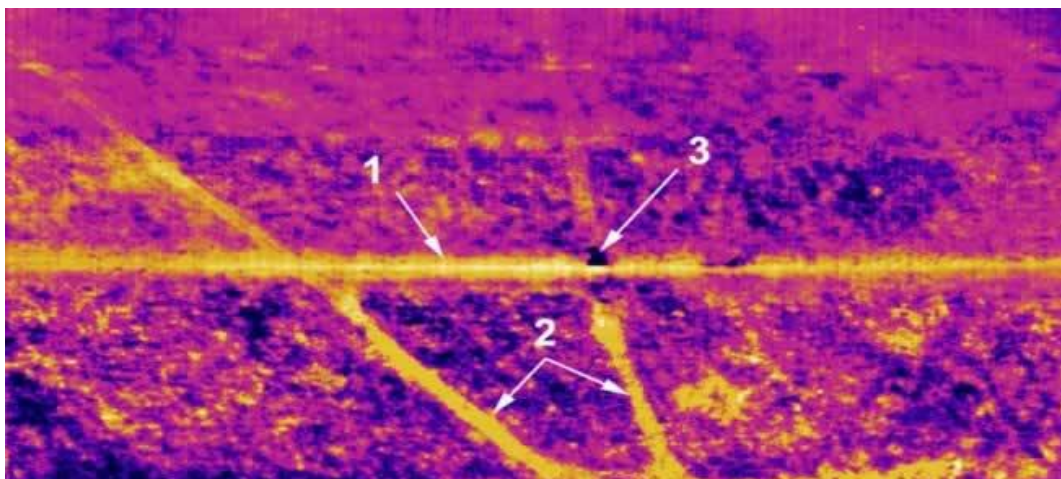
Пример подземной утечки газа из газопровода: 1 – “нитка” газопровода; 2 – грунтовые дороги; 3 – подземная утечка газа
